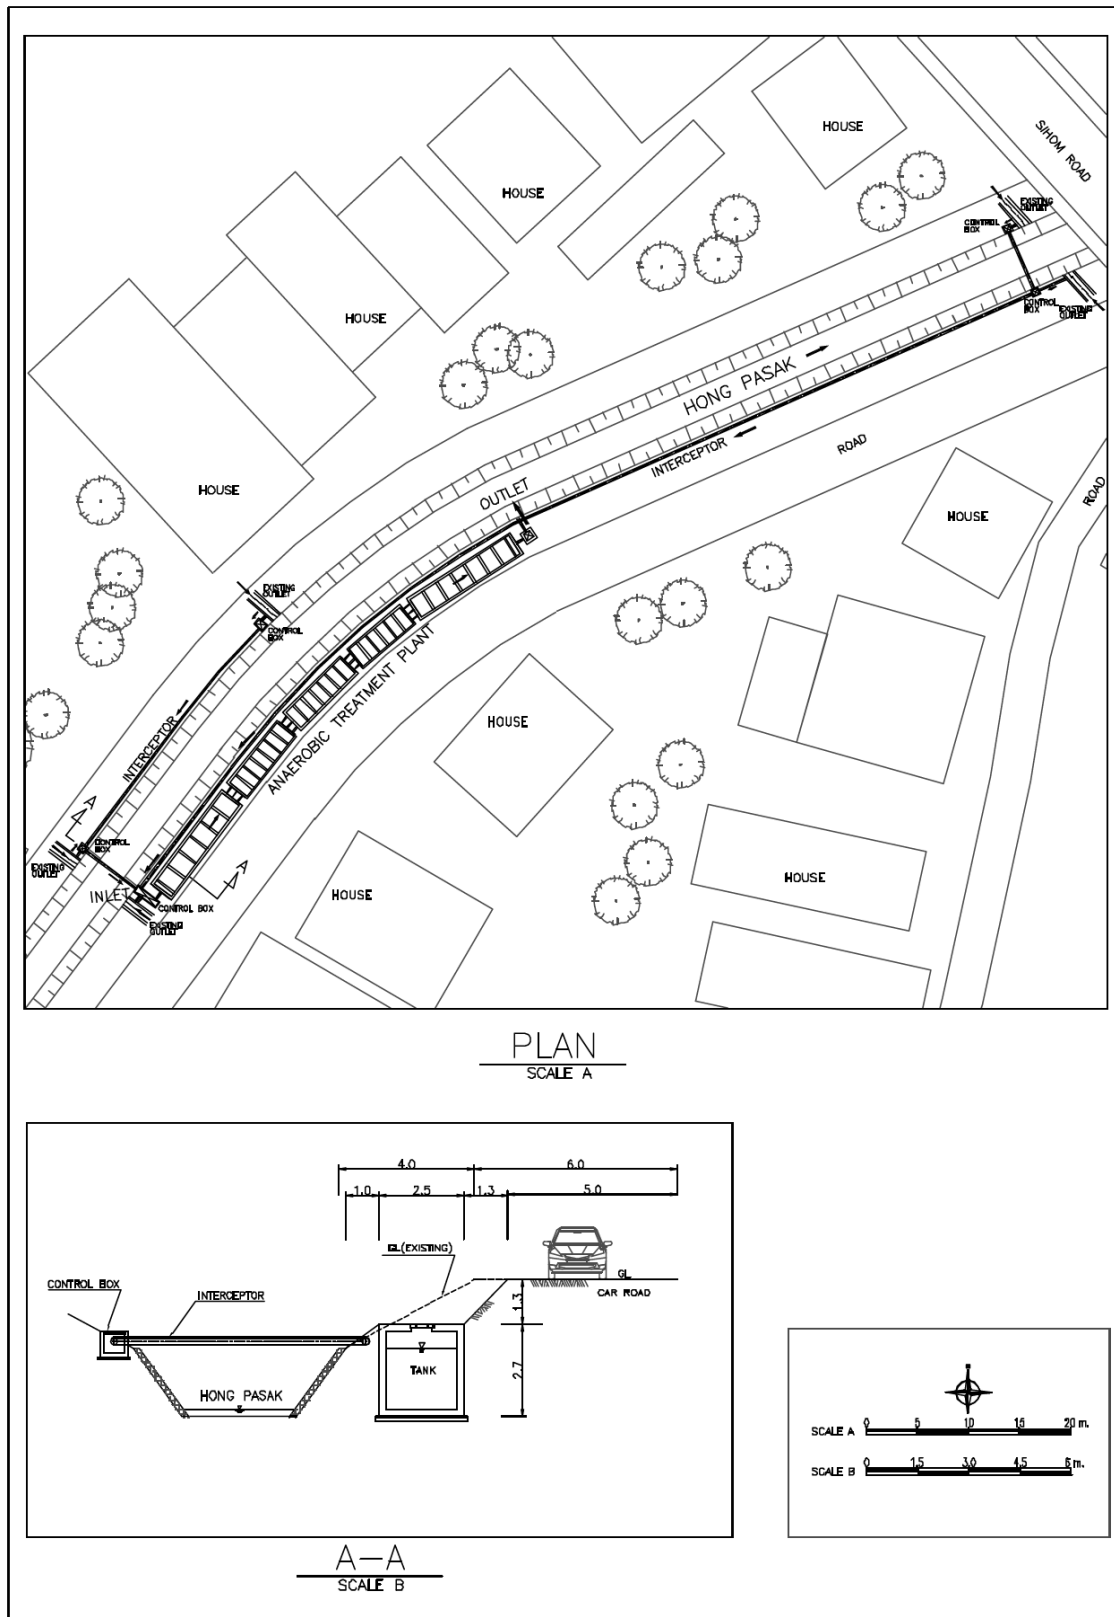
分散型簡易処理施設 (T5) の例 (平面図および標準断面図)
